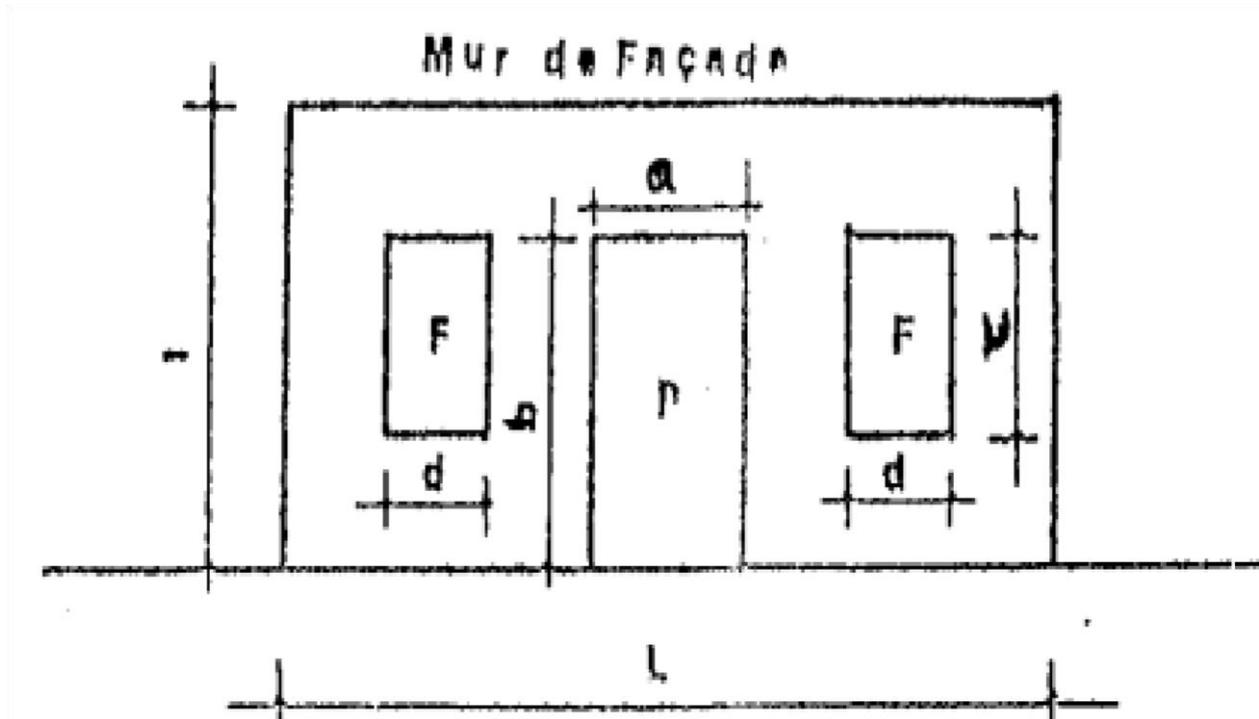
Mur de façade en brique (Exercice 5.1)
